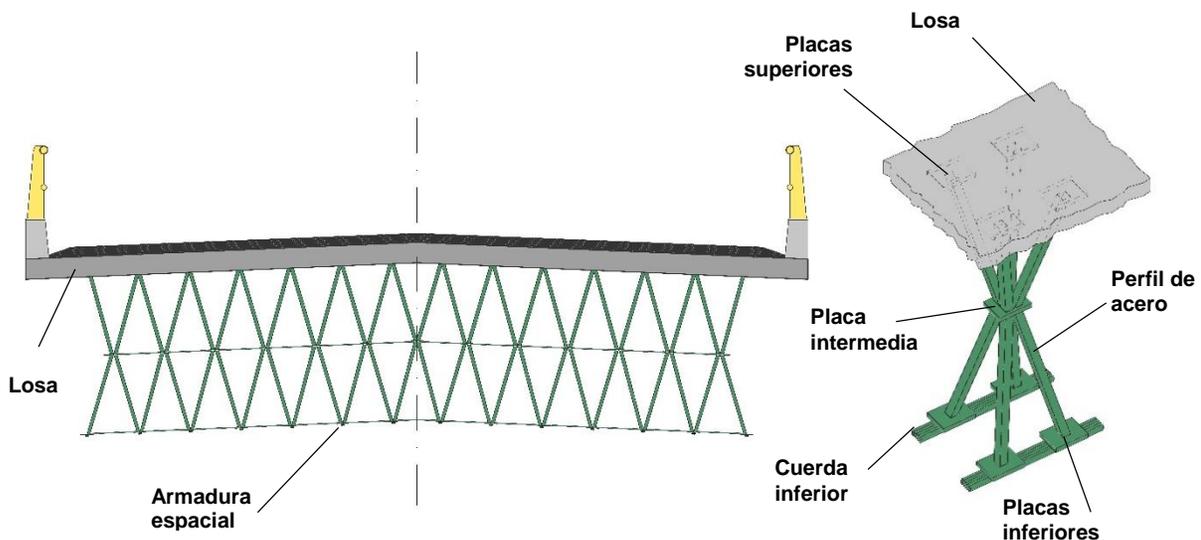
Superestructura de losa sobre armadura espacial y detalle de piña
